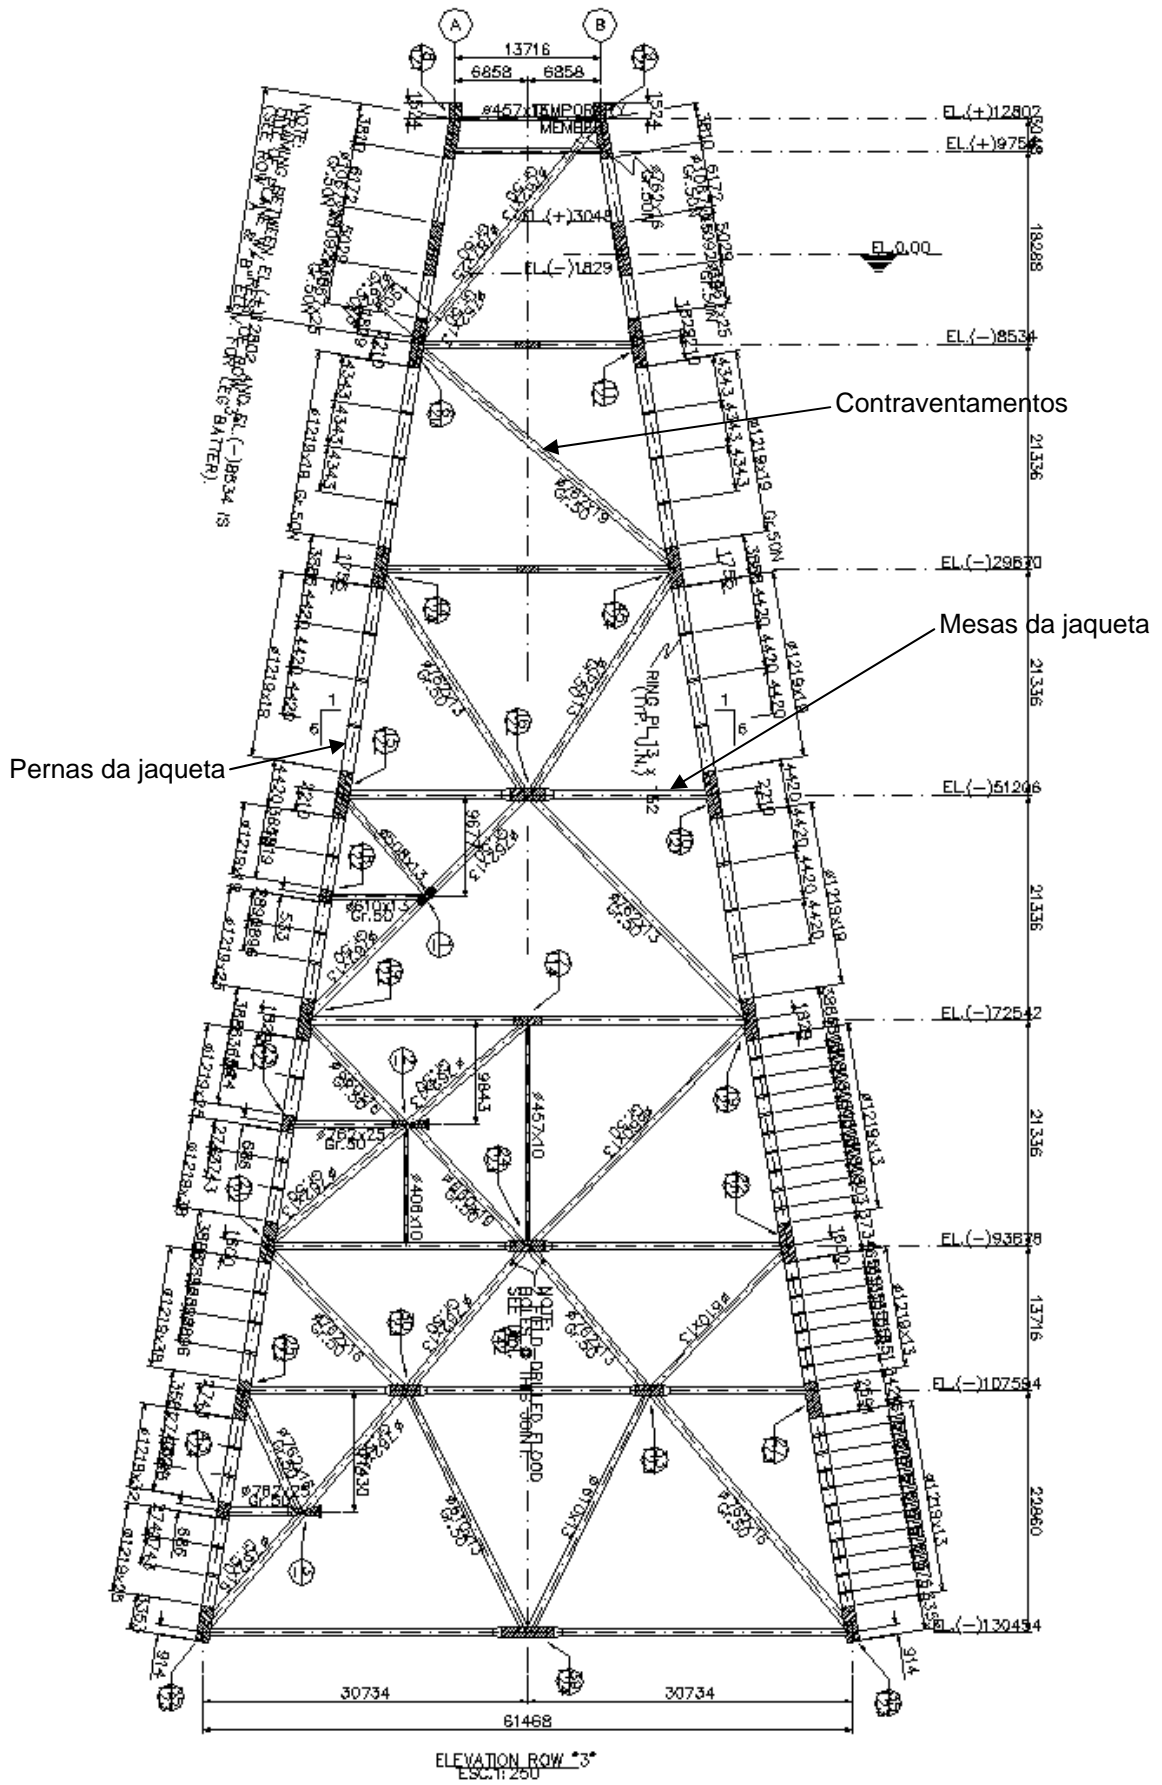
Jaqueta – Elevação do Eixo 3 (cotas em mm)
